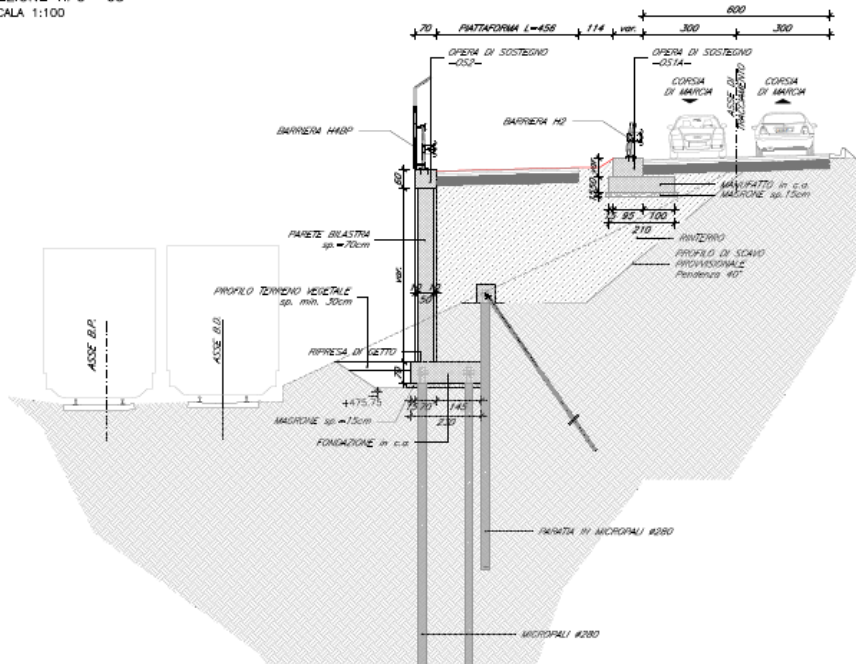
Viabilità di accesso – Sezione tipologica 3
